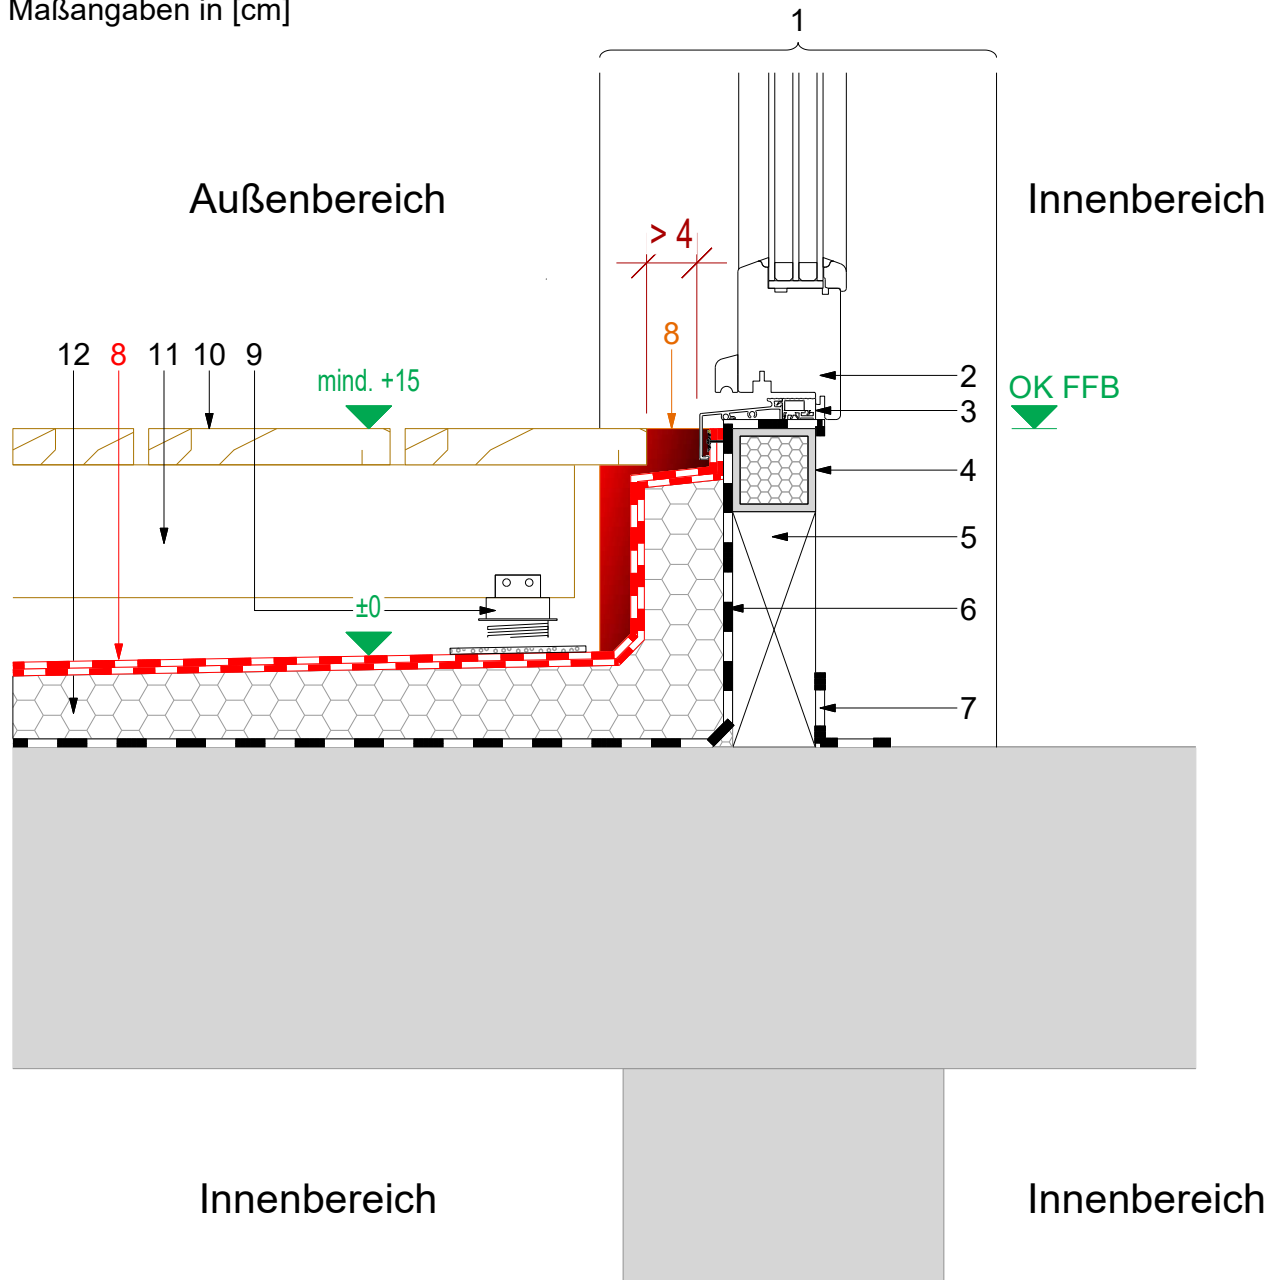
Abbildung 18: Ebenerdiger Austritt, offener Terrassenbelag
